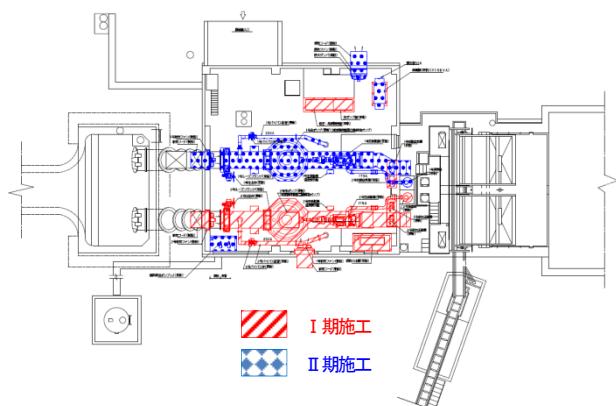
施工範囲図（Ⅰ期、Ⅱ期）
